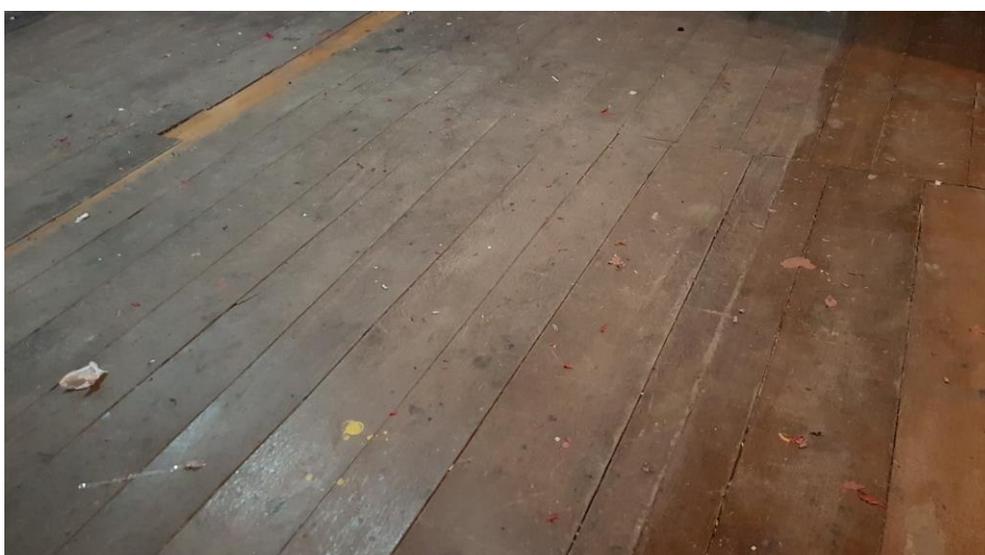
Rastreles apoyados en las bovedillas. Tabique sobre la tarima. Planta primera
